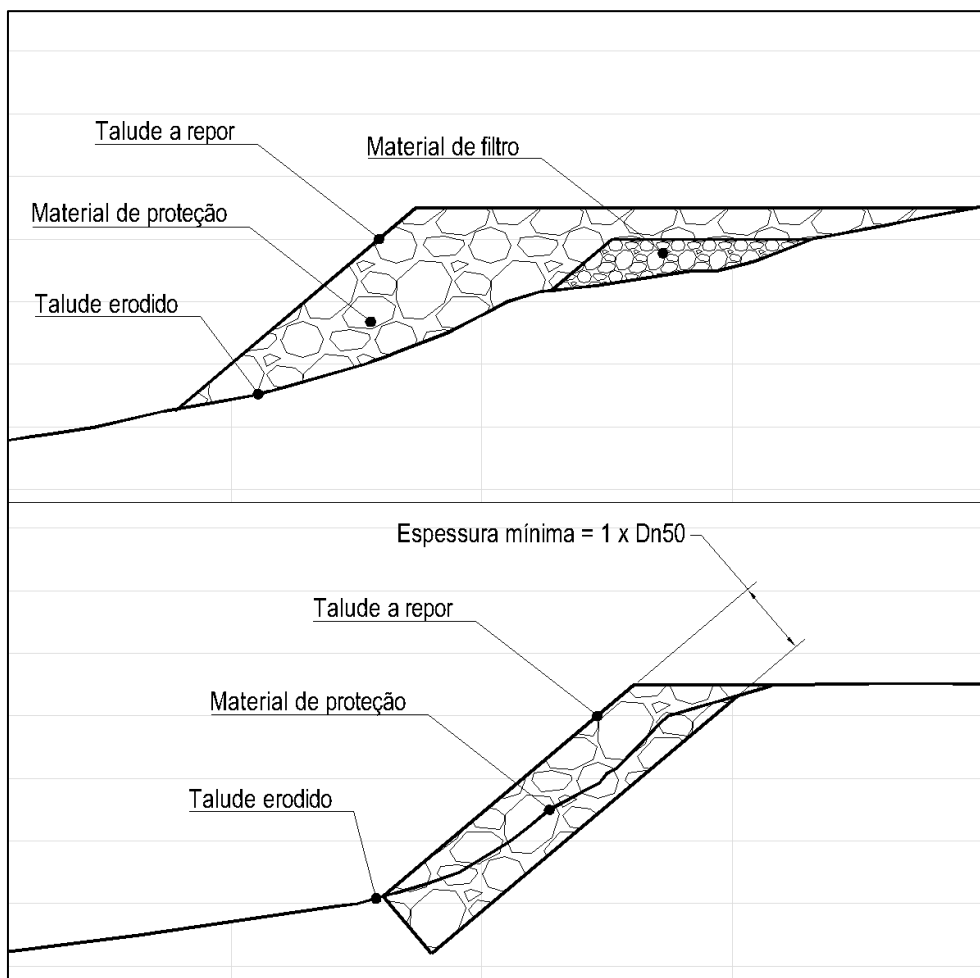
Disposição de material em obras de reabilitação por reposição.
